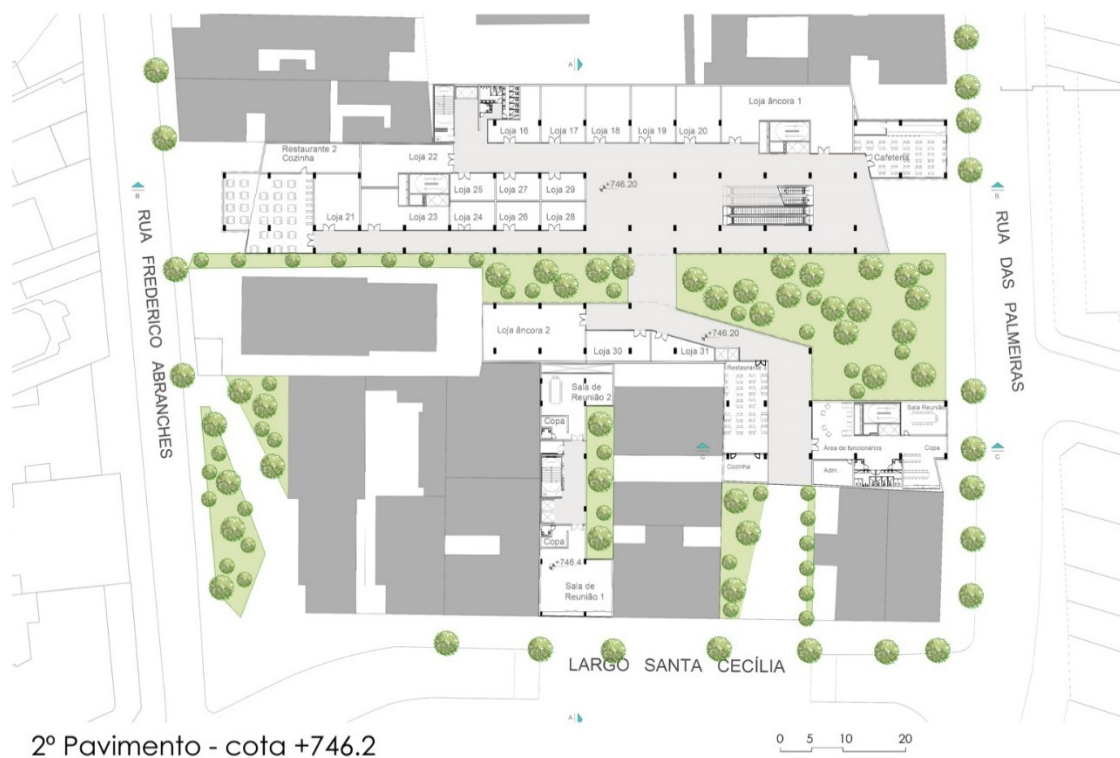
Planta do 2º pavimento. Fonte: AUTORIA PRÓPRIA, 2019.
